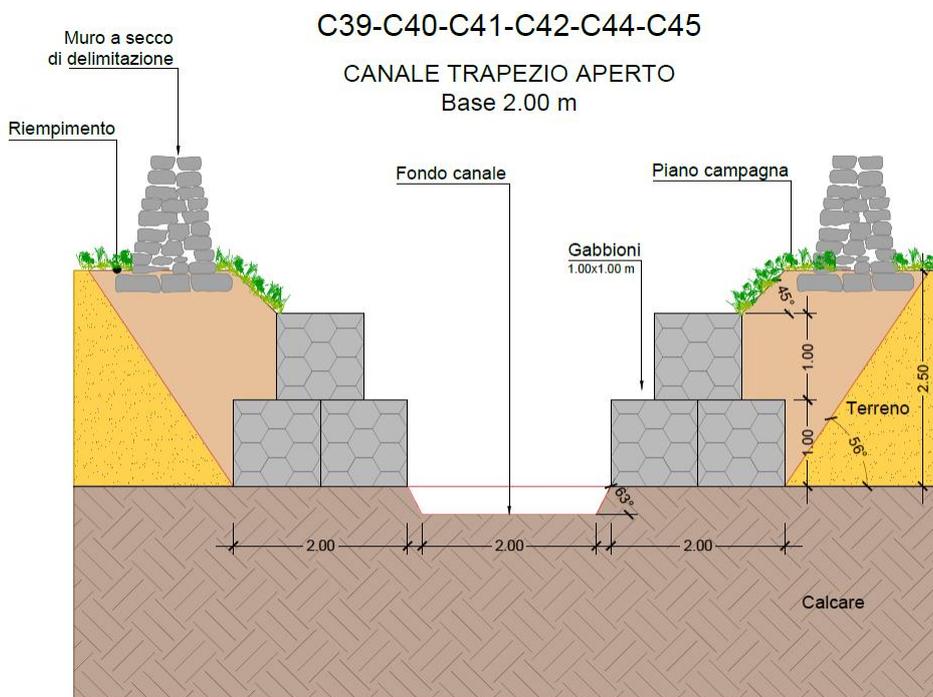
Sezione tipo di canale delimitato su entrambi i lati da muretti a secco
